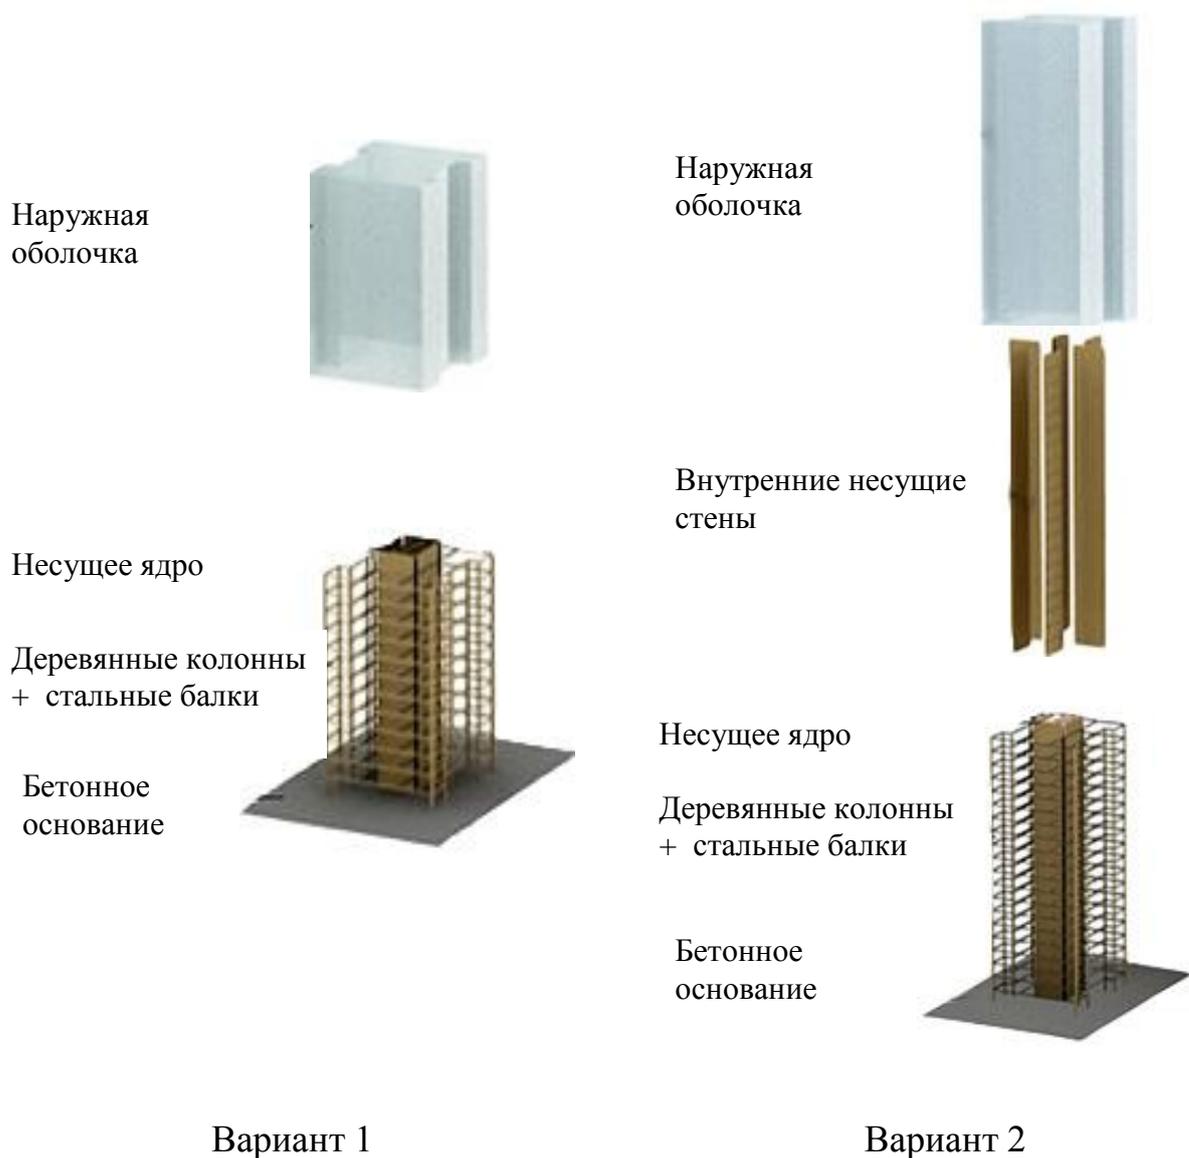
Варианты для строительства деревянных зданий высотой до 12 и 20 этажей
